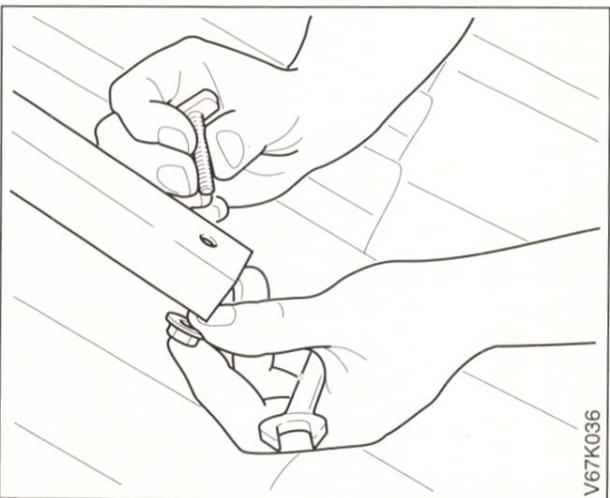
Hammerkopfschrauben für Kollektorbefestigung (M8x50) in die Bohrungen der Montageschienen stecken und Mutter mit Unterlegscheibe locker aufschrauben (siehe Seite 4).
